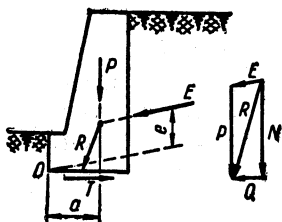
Расчетная схема массивной подпорной стенки при расчете на устойчивость.
